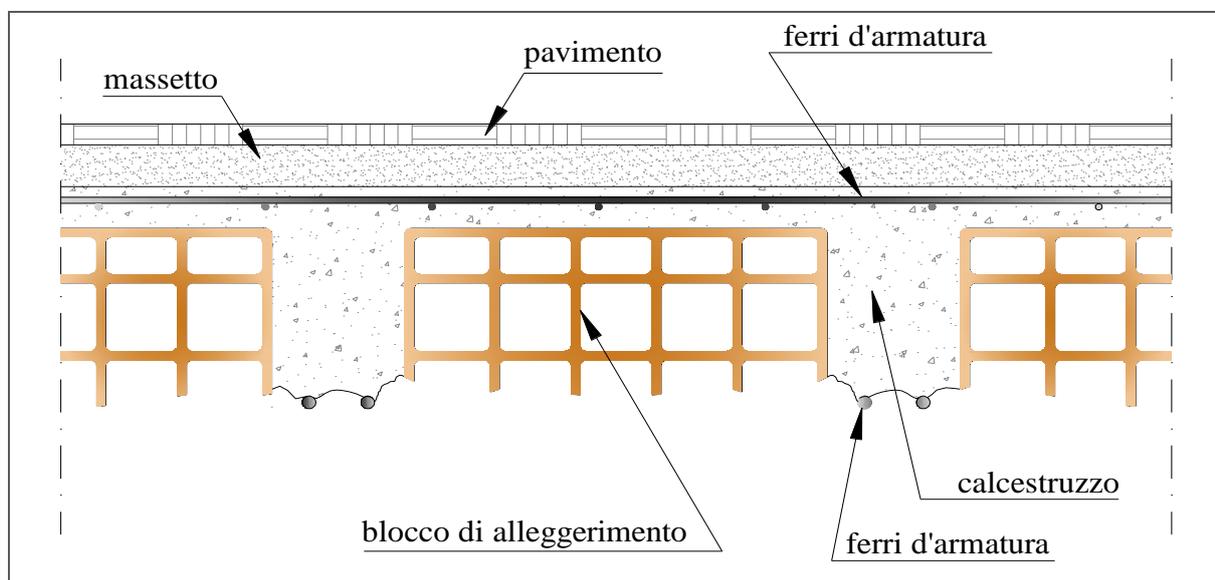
Sezione tipica di un solaio in laterocemento: schematizzazione del fenomeno.
